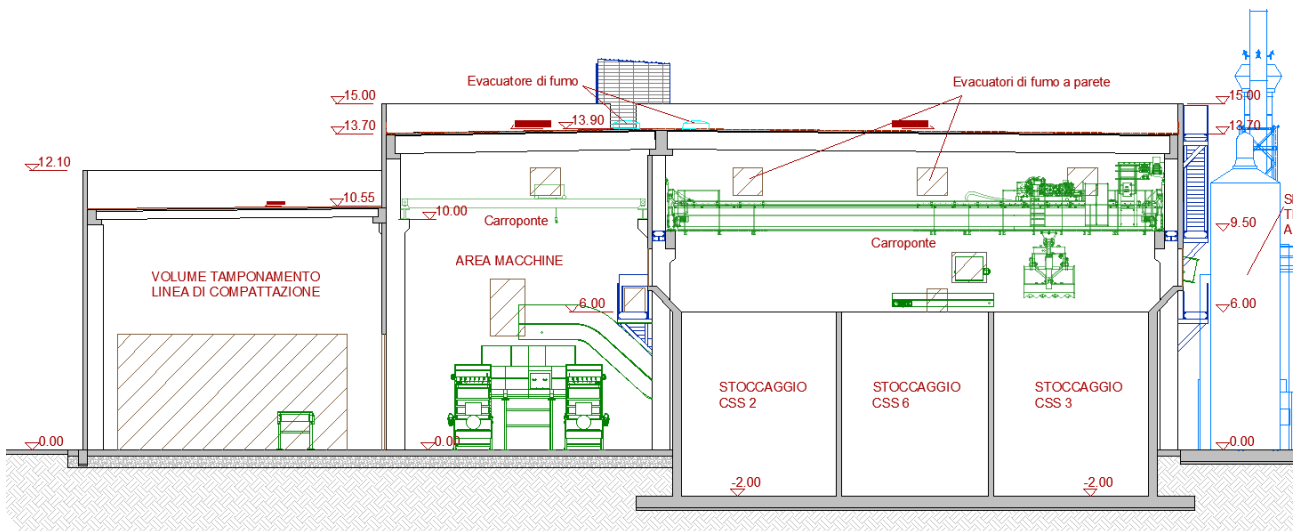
Sezione presentata nella versione attuale del progetto – Impianto SRA
